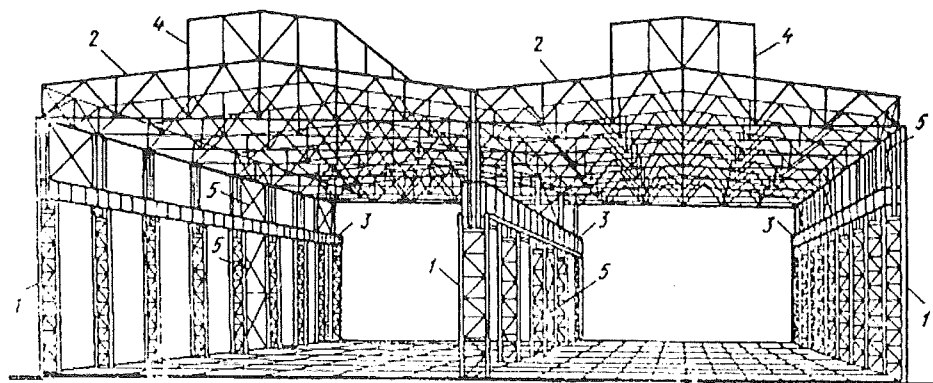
Конструктивная схема каркаса двухпролетного производственного здания
